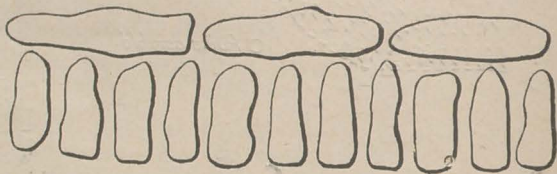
PLAN AU 1/40<sup>e</sup> DE FONDATIONS A IGHQOUR
